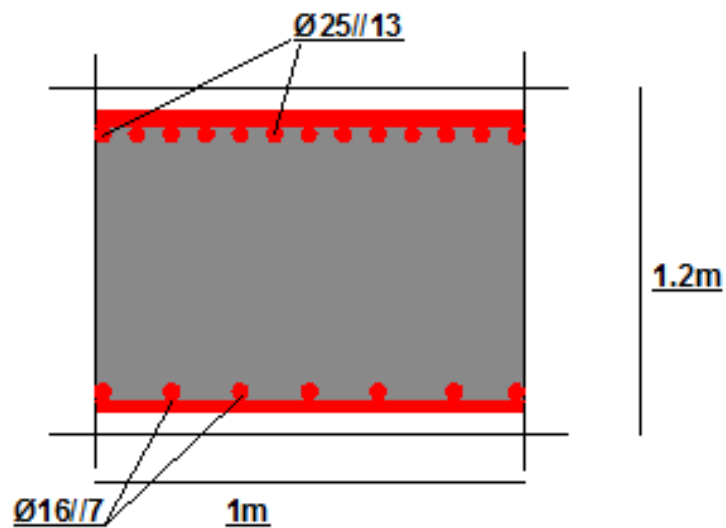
Schéma de ferrailage à mis travée dans la direction longitudinale
